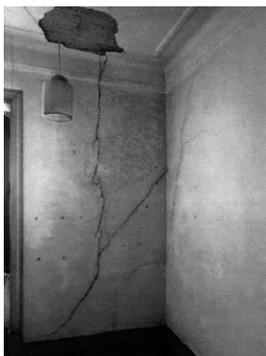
Fissuração nas paredes de empena e nas transversais a esta.
